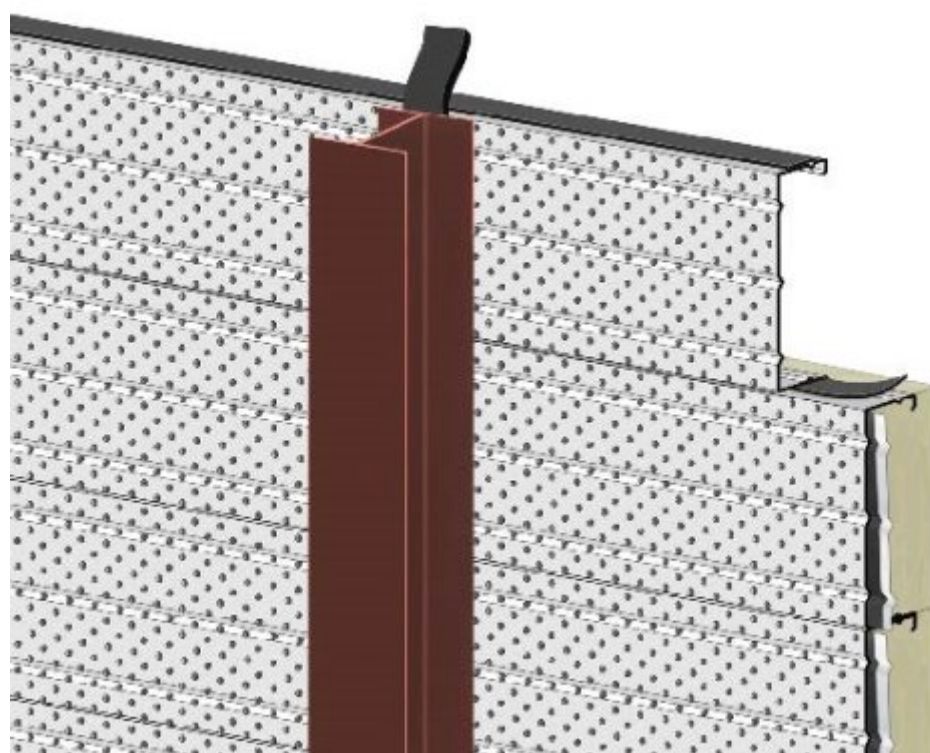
ter – Mise en place du joint d'étanchéité SUPER ETANCOPAST sur plateaux métalliques perforés
